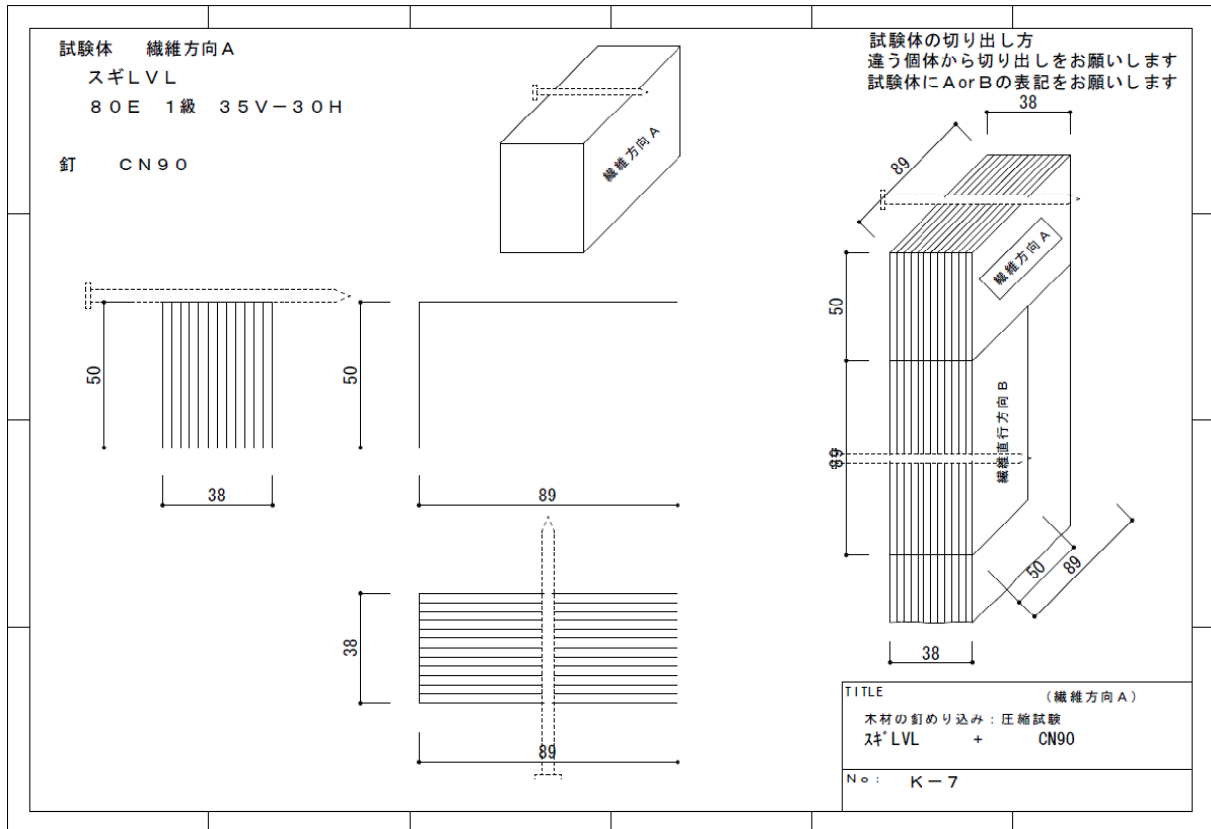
K-7 試験体図 (スギ LVL80E)
